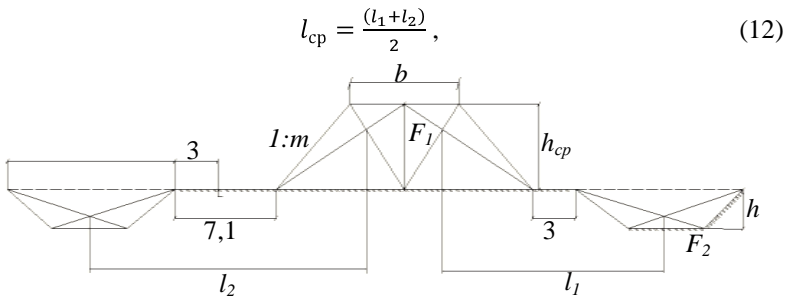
Схема к расчету средней дальности перемещения грунта из резерва в насыпь
